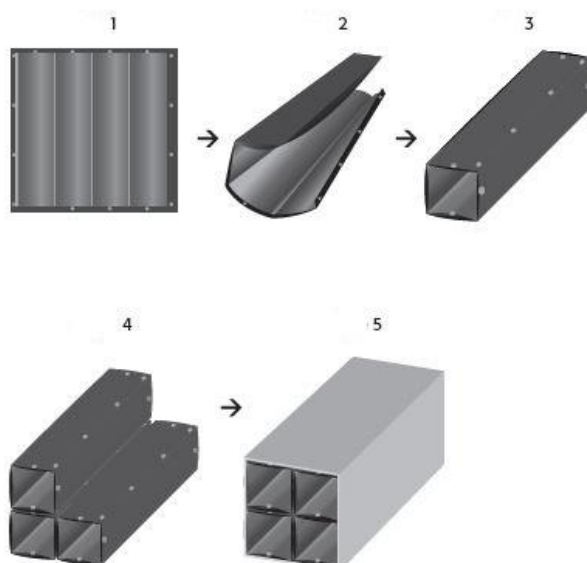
Figura I. Modalità d'installazione del silenziatore fonoassorbente modulare Alveo.
